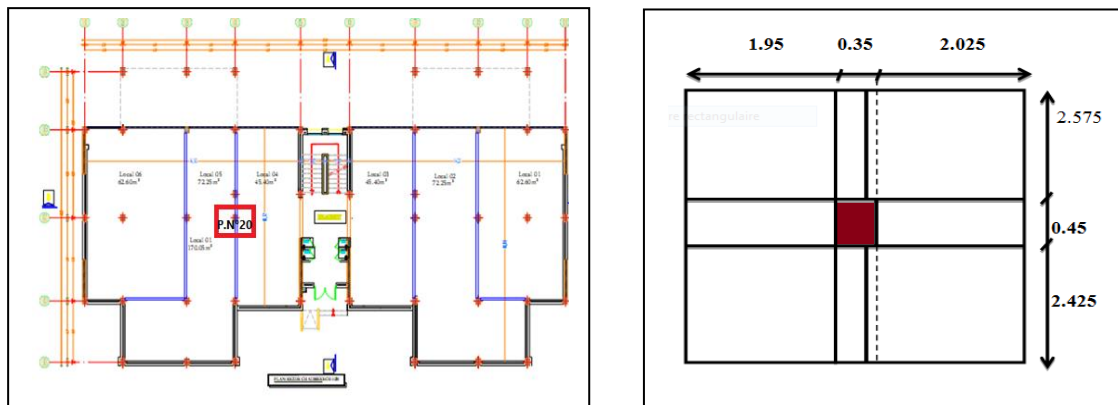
position et schéma de poteau la plus sollicité (surface afférente)
